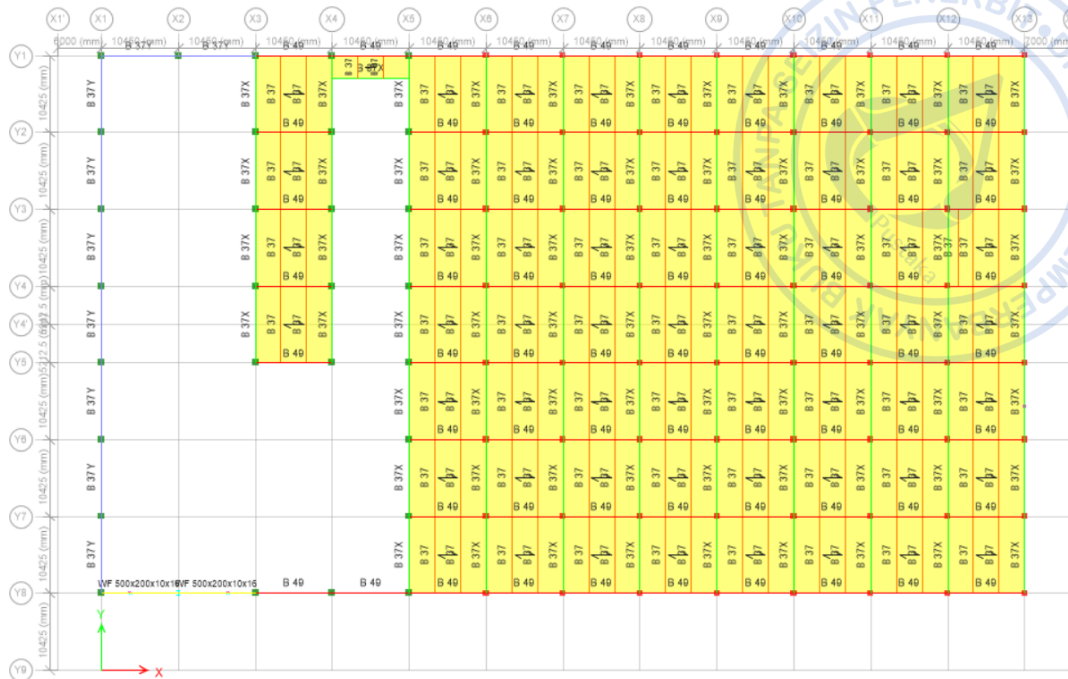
70. Balok yang Telah dimodelkan Pada Lantai 2
